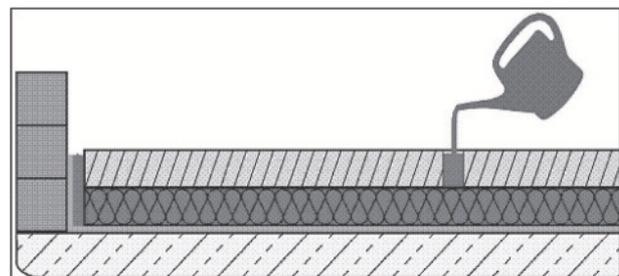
Eine Desinfektionsspülung garantiert, dass alle Bereiche unterhalb des Estrichs desinfiziert werden.
